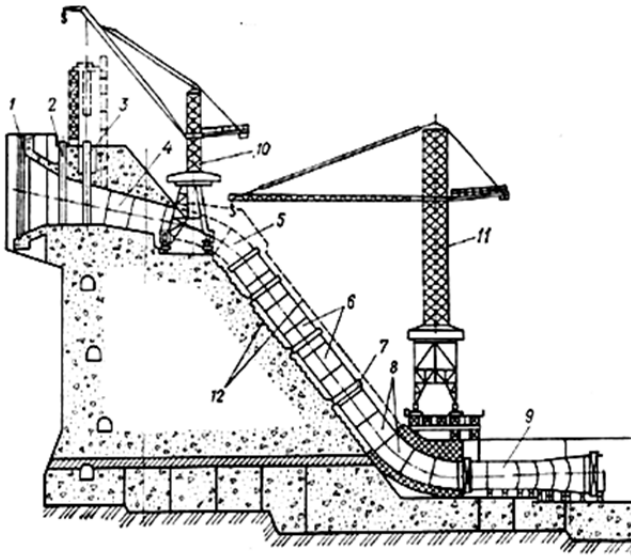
Монтаж турбінного трубопроводу ГЕС
